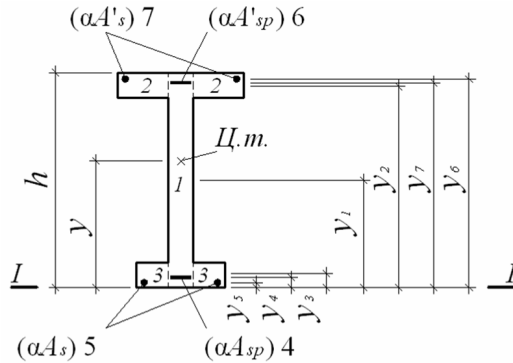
Схема к определению геометрических характеристик приведенного сечения: 1–3 элементарные площади бетонного сечения; 4–7 арматура; y_1 – y_7 – расстояния до центров тяжести одноименных элементов сечения
